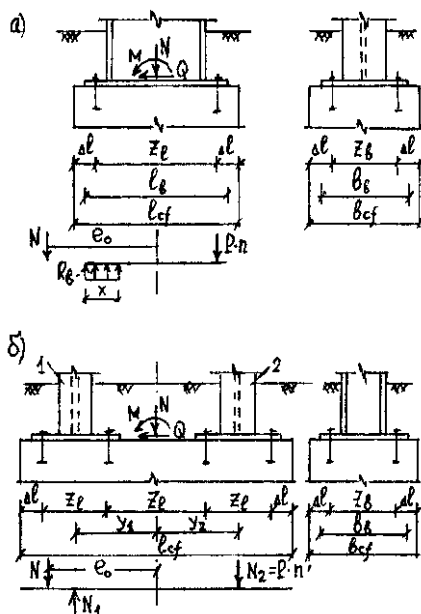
Расчётные схемы для определения усилий в анкерных болтах стальных колонн: а – сплошного типа, б – сквозного типа
